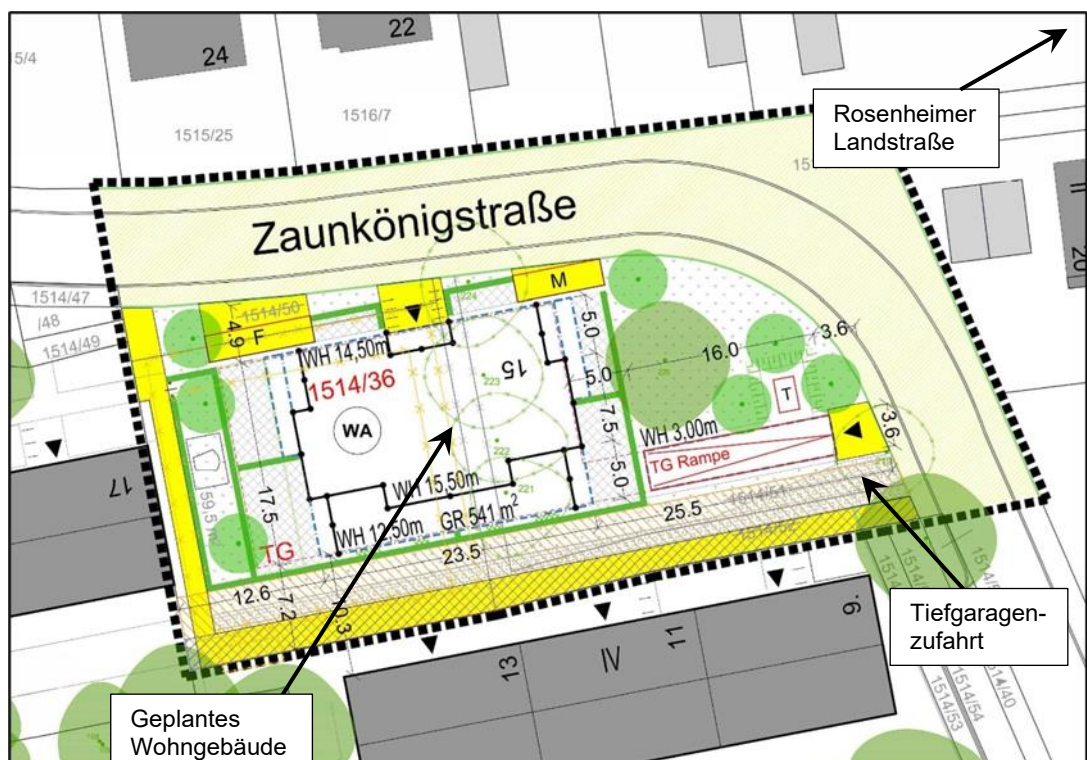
Bebauungsplan „Zaunkönigstraße“ mit Bezeichnung der Plangebäude (Ausschnitt aus [1]).
